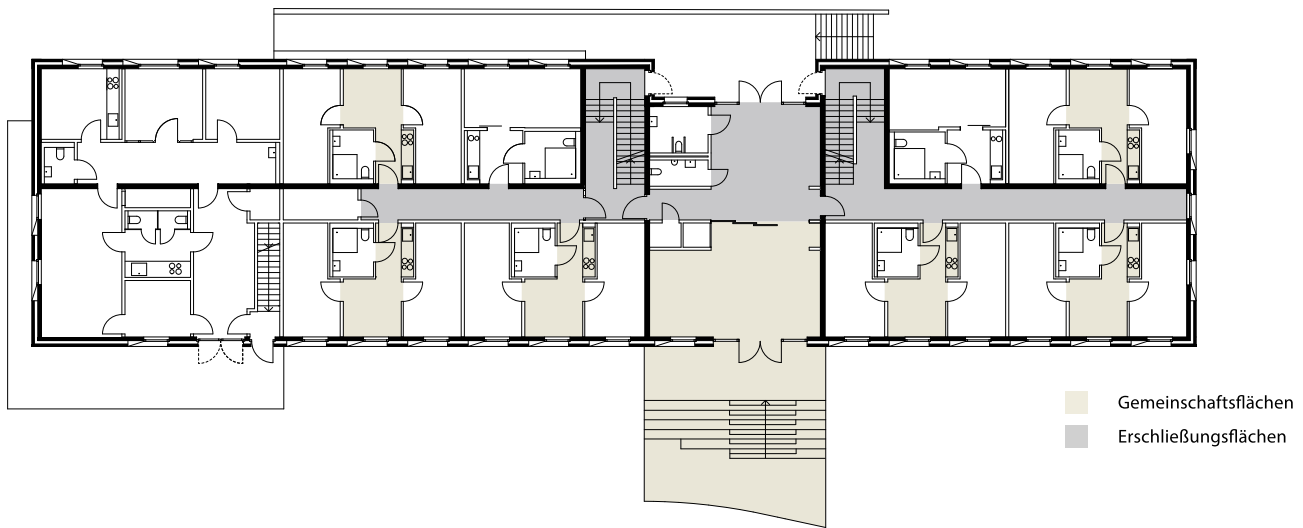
Grundriss Erdgeschoss, M. 1:375 [© BF Vario]
